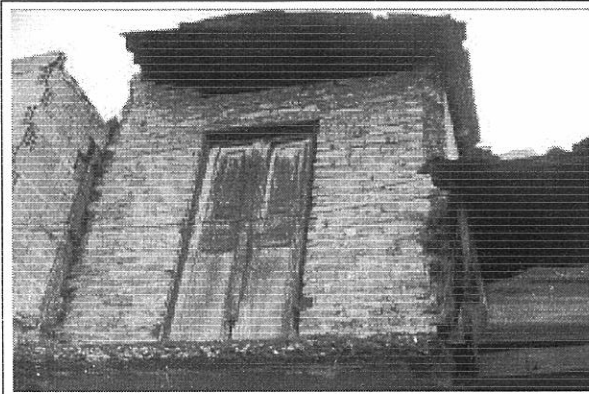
Unidades de mampostería sueltas en parte superior de muro de fachada
